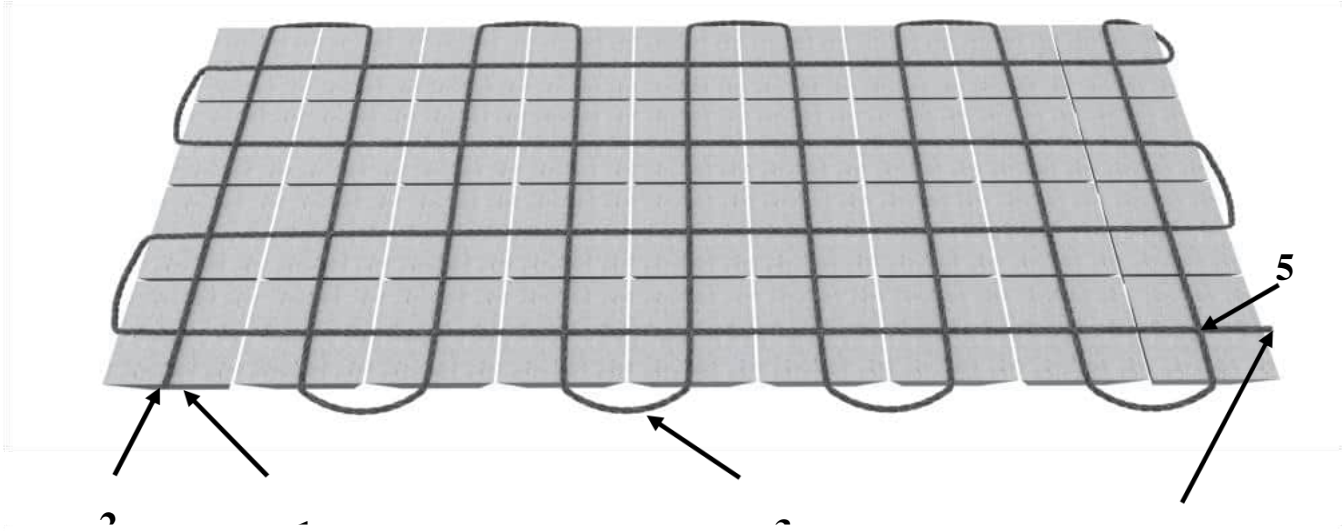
Укладка соединительного арматурного каната в формообразующую оснастку плит моделей 105, 202, 405
